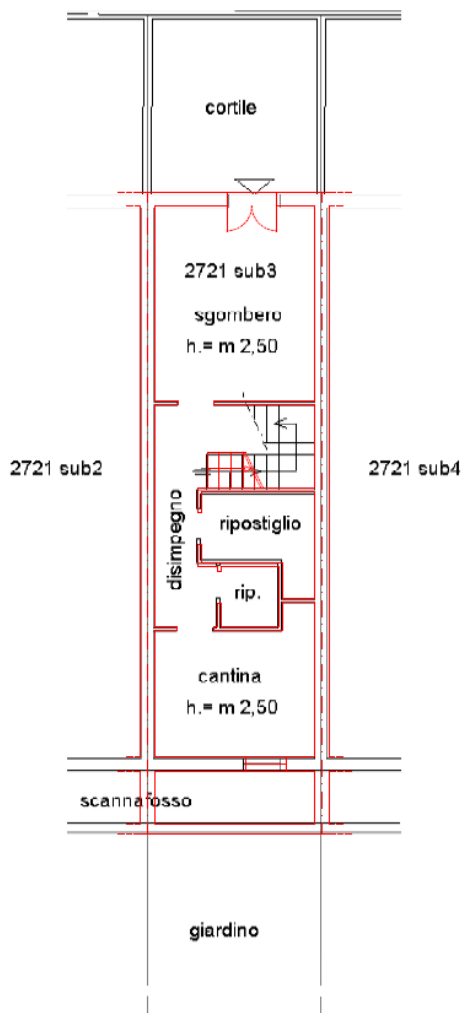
Sovrapposizione rilievo con planimetria catastale in atti (fuori scala). Piano seminterrato
